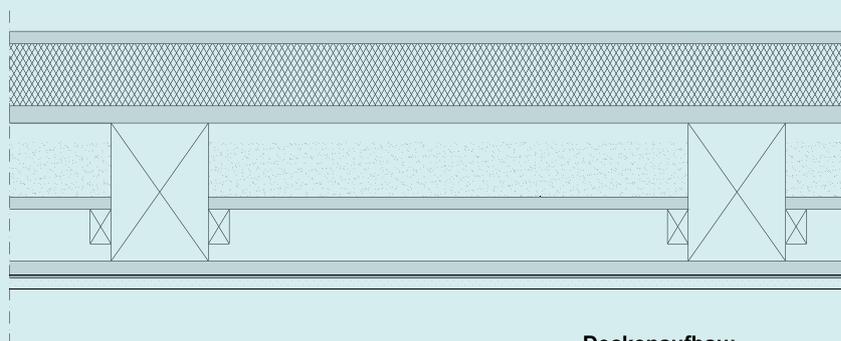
Schnitt Deckenaufbau Dachstuhl Bestand
